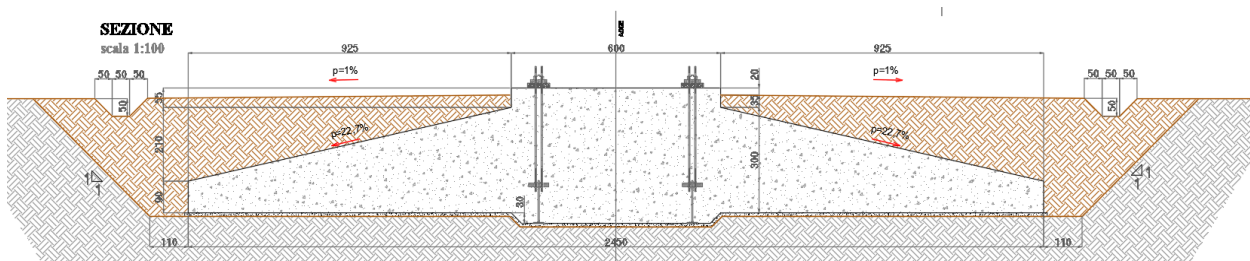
Geometria della fondazione diretta dell'aerogeneratore
